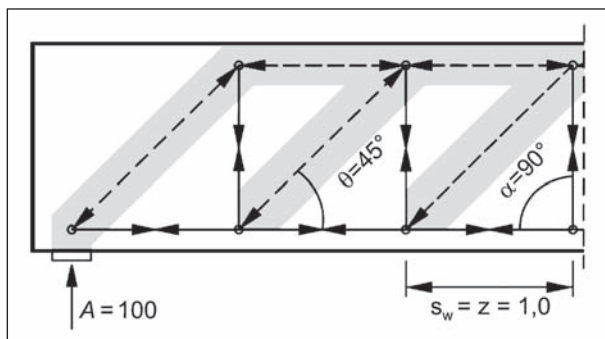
Einfaches Fachwerk mit 45° geneigten Druckstreben
